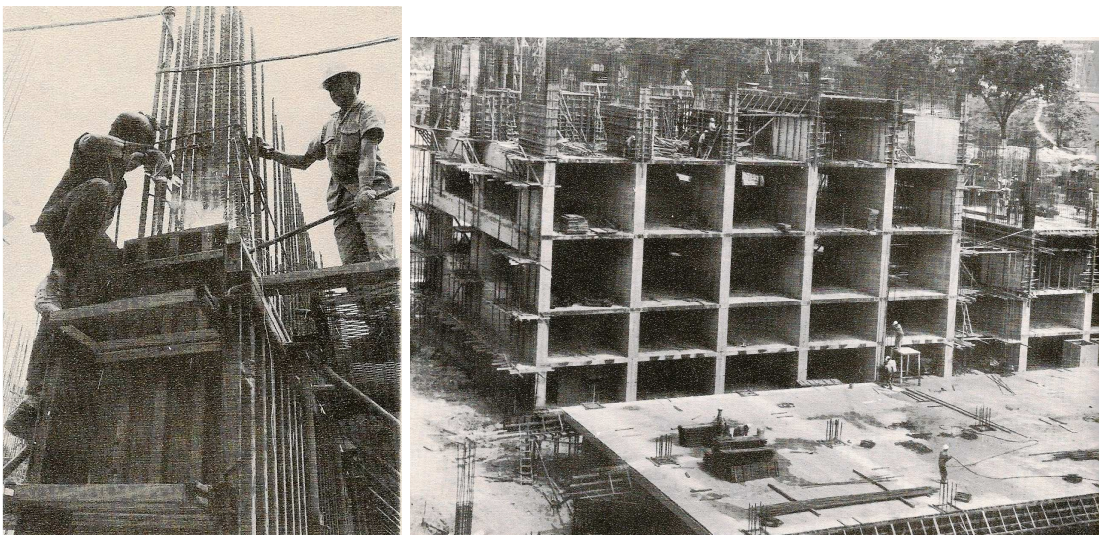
Construcción de Bloque de Viviendas y Apartamentos de Parque Central.
